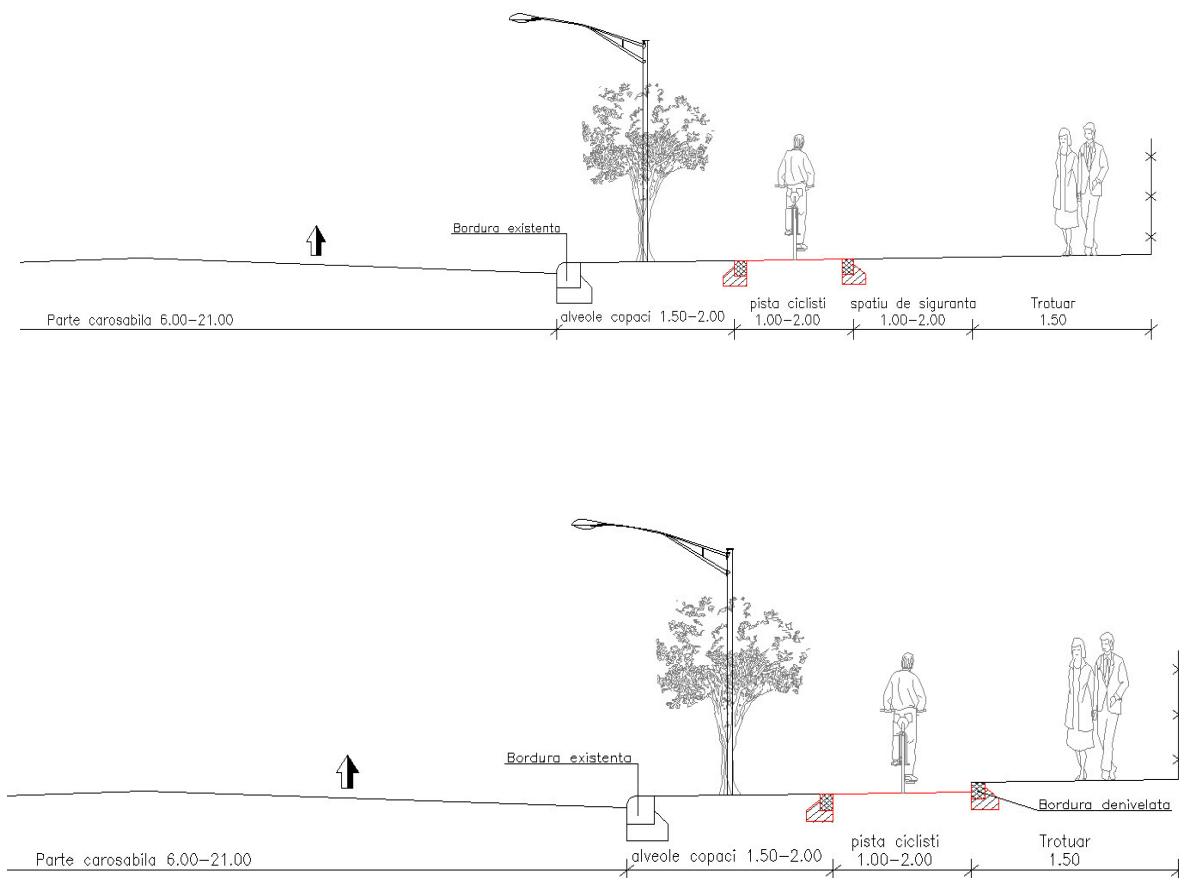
Profiluri transversale străzi conform STAS 10144
